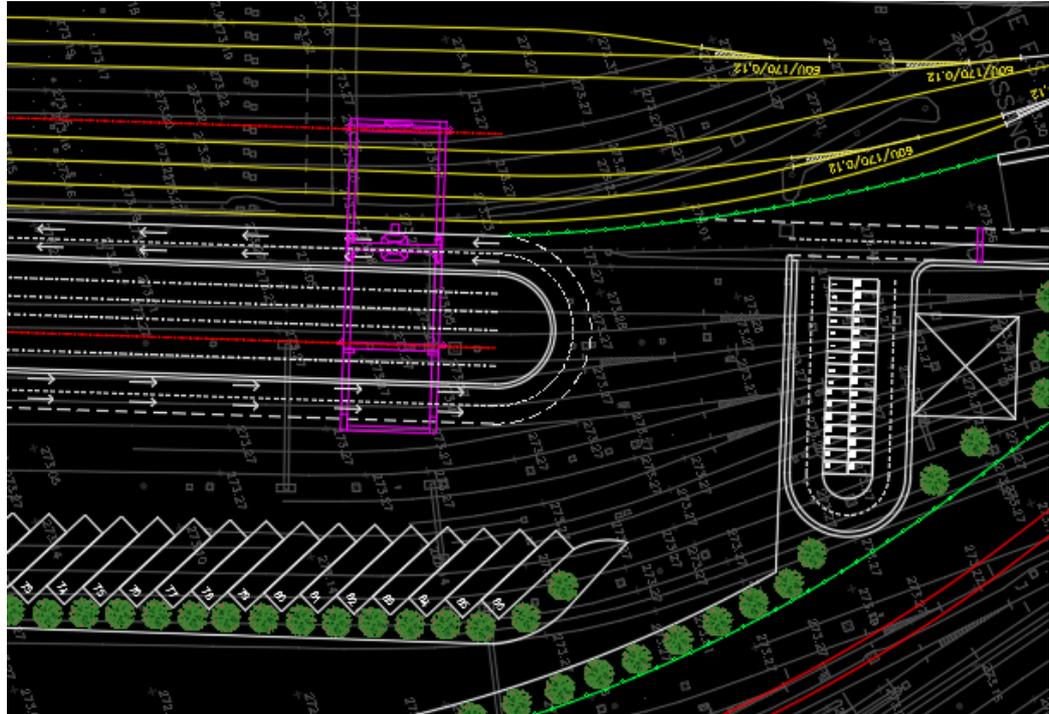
Estratto Autocad zona d'ingresso del terminal gateway
